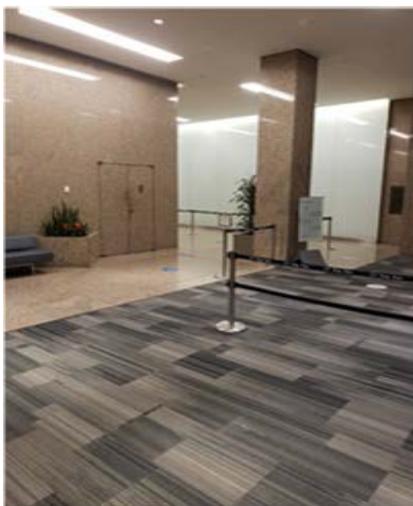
Photo de l'intérieur de la zone du quai de chargement en direction de la porte du monte-charge
